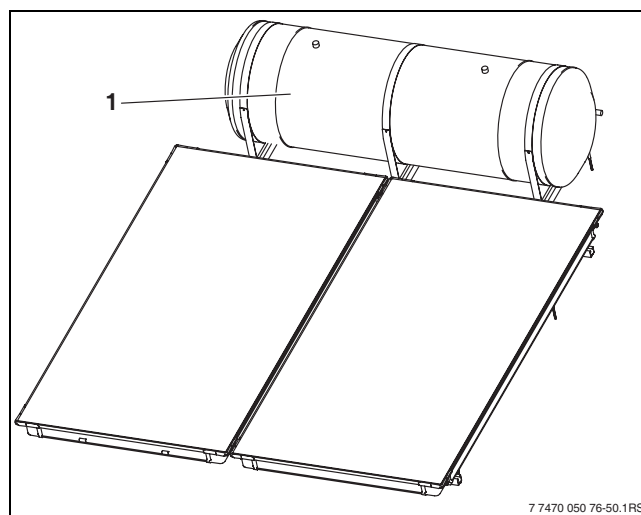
Vista montaje en tejado inclinado (sistema de 300 l)
